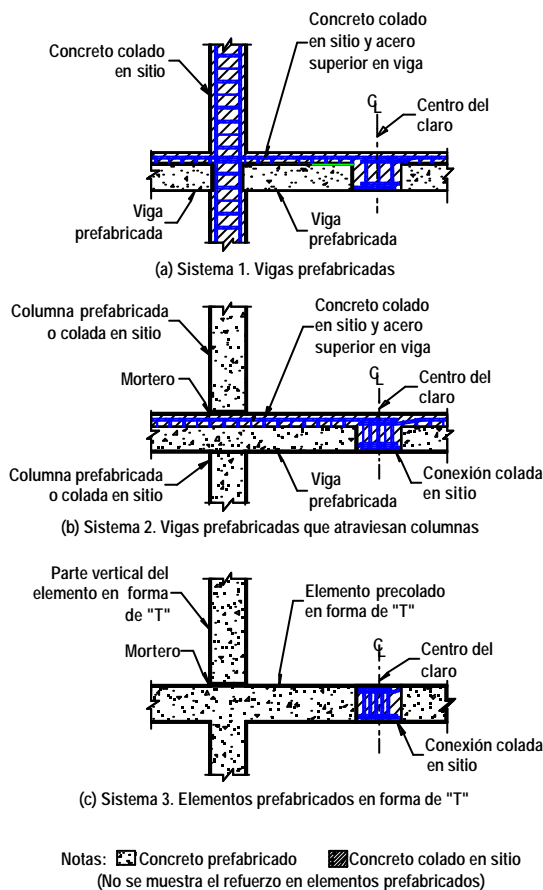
Ejemplos de conexiones para elementos prefabricados (Park, 1995)
